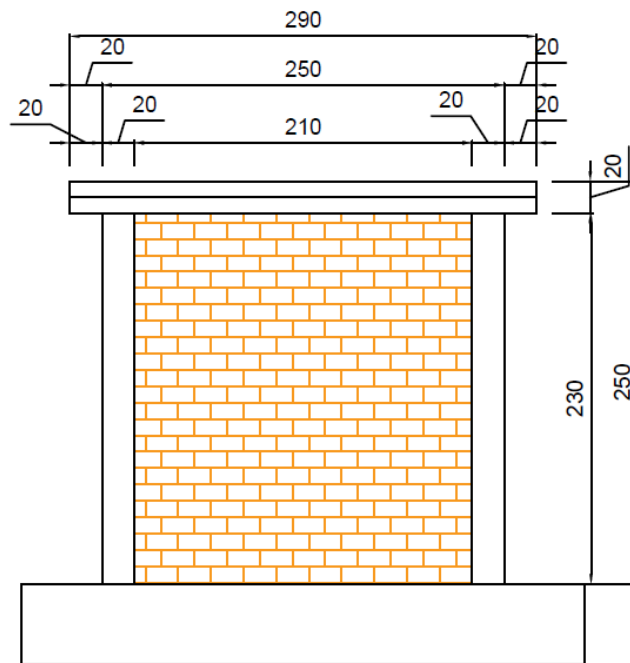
Geometría de muro de prueba (dimensiones en cm).
